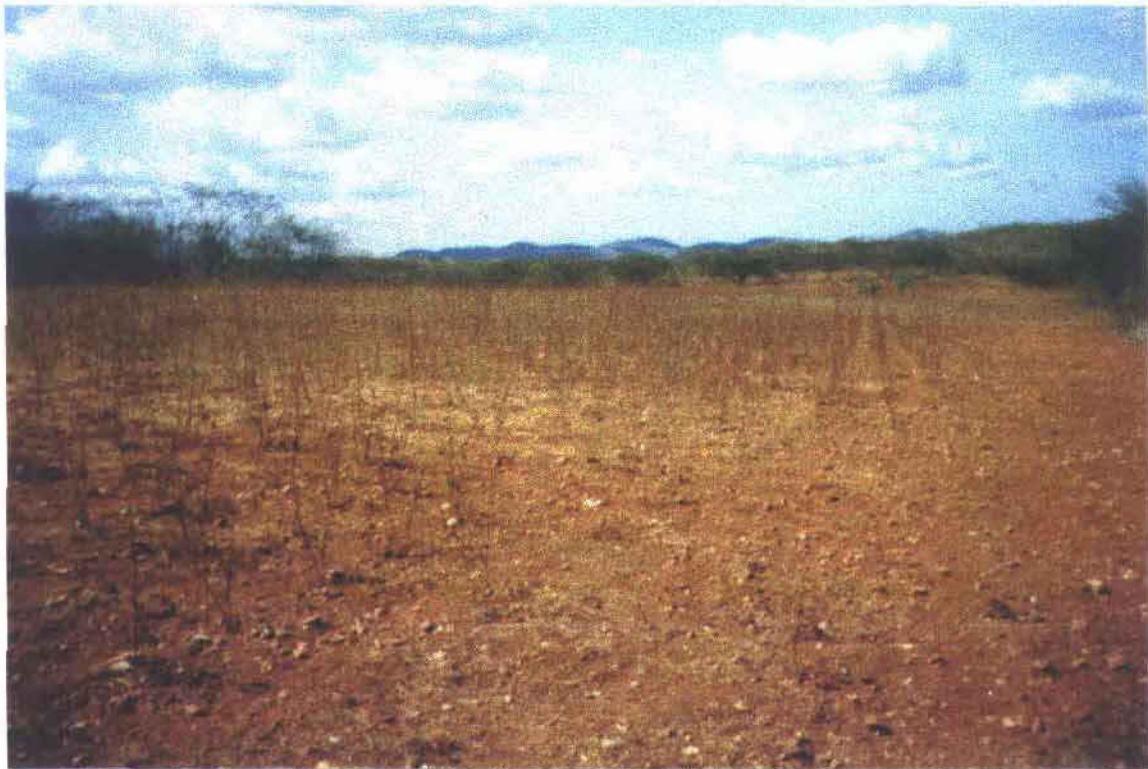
Vista longitudinal da Jazida Terrosa JT-03.
